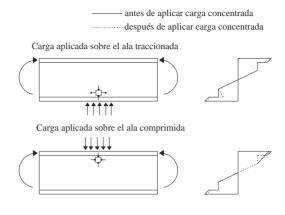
Comportamiento a cargas concentradas en vigas híbridas (Schillings, 1967)
